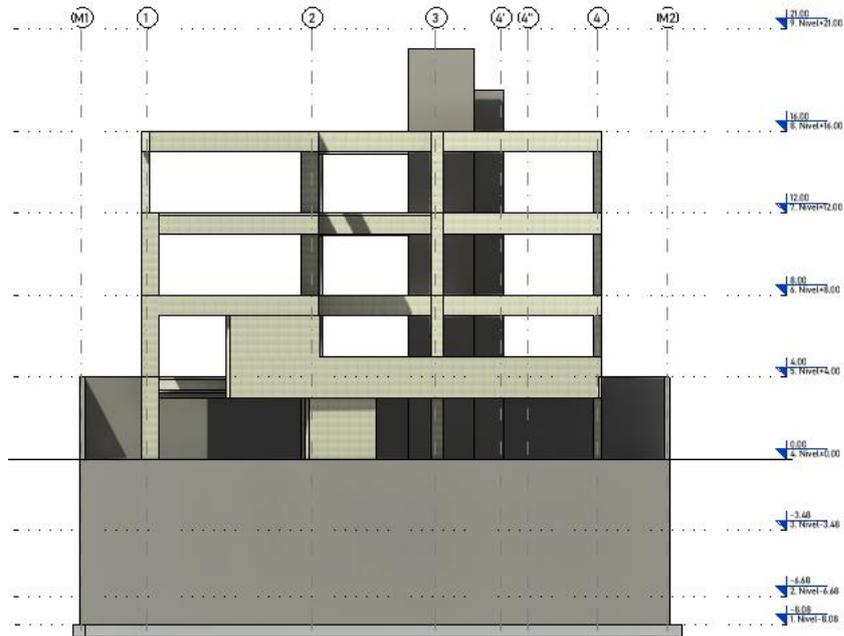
Fachada Este Modelo Estructural 3D. (Elaboración Propia)
